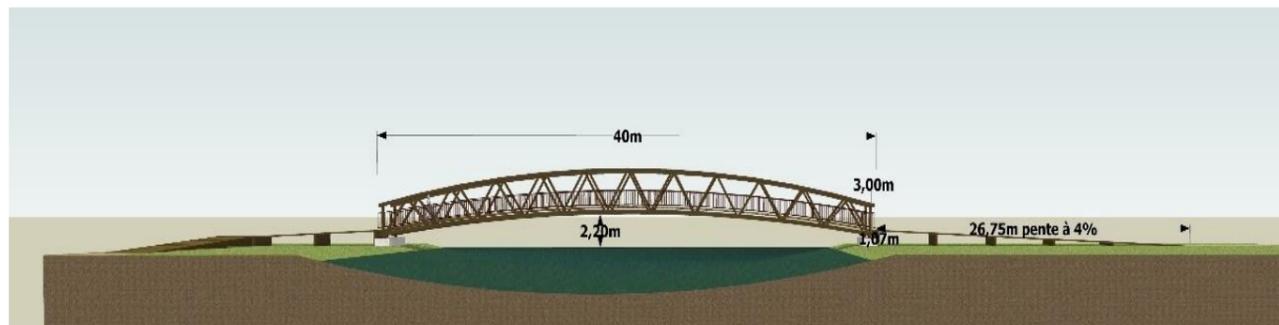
La coupe transversale Passerelle avec Rampes d'accès
